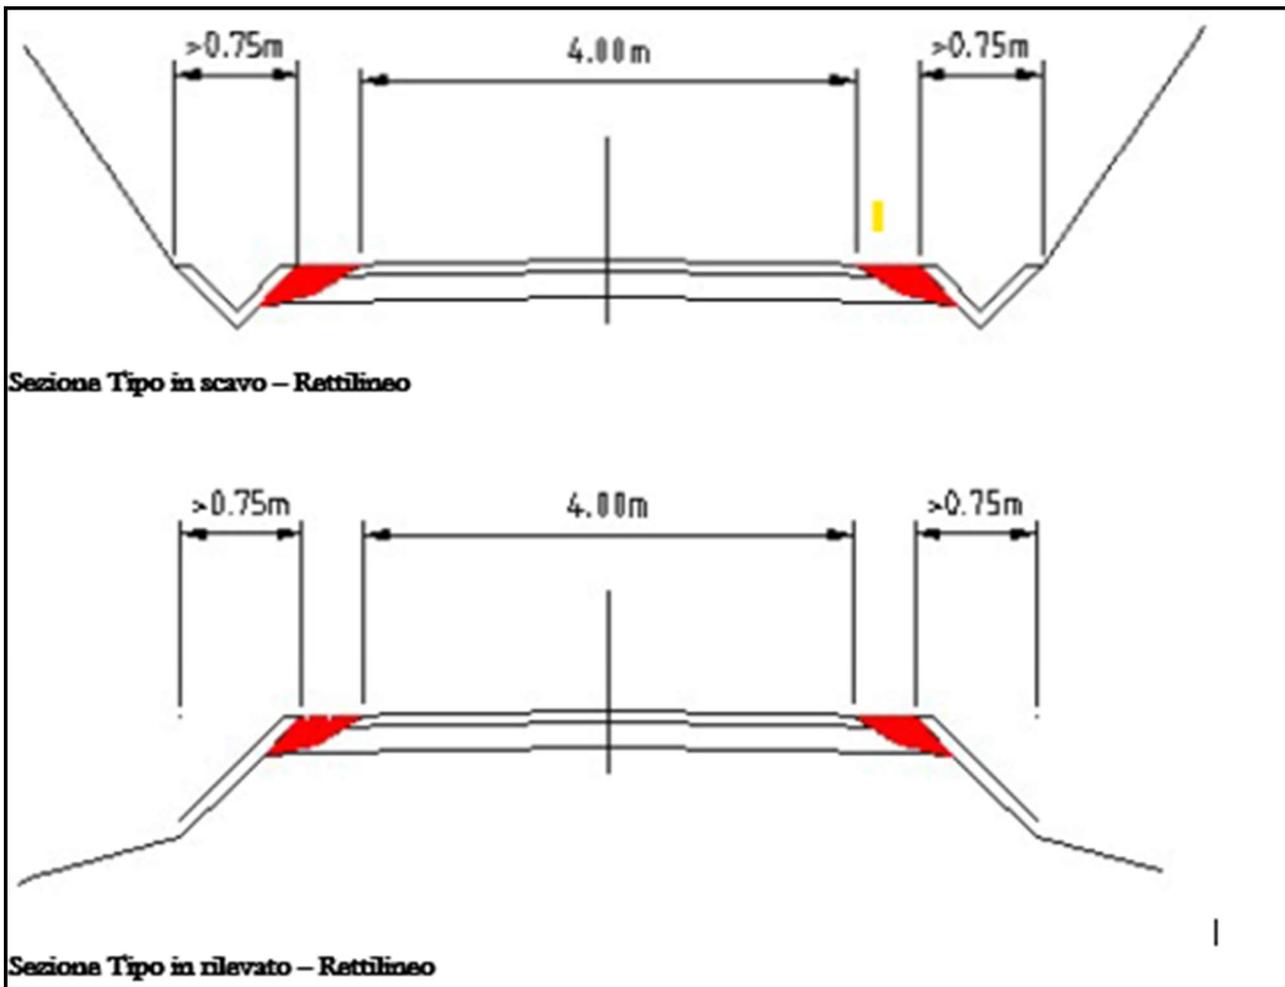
Sezioni tipo viabilità parco eolico
